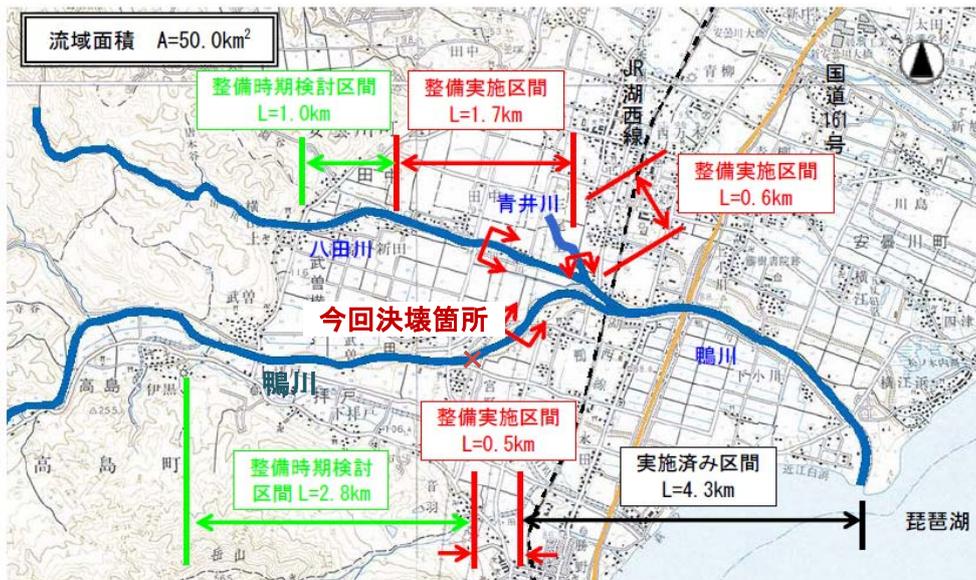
鴨川の改修計画案平面図²⁰⁾
